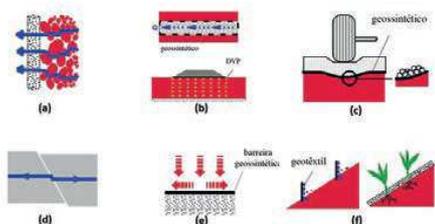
Principais funções desempenhadas pelos geossintéticos (adaptado de [2]): (a) filtração; (b) drenagem; (c) separação; (d) reforço; (e) impermeabilização (ou barreira); (f) controlo da erosão.
